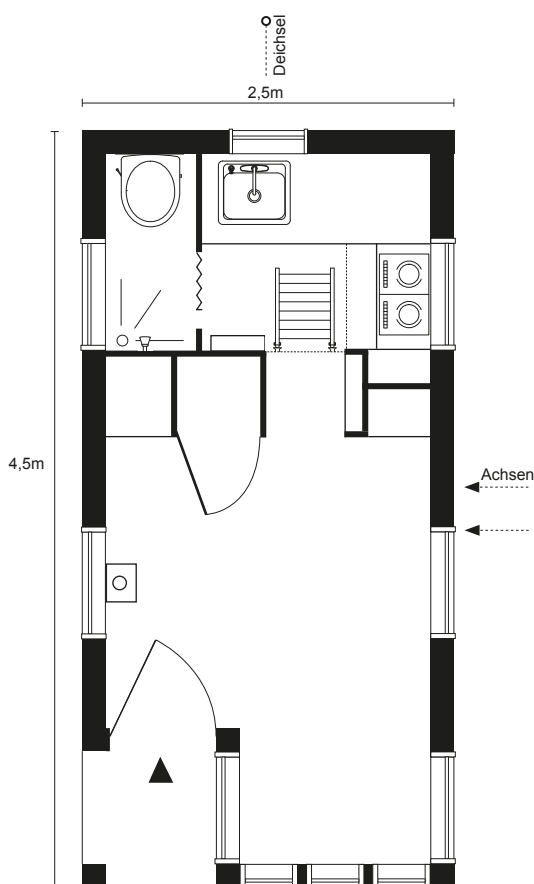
adaptierter Grundriss "Weebee"<sup>44</sup>
